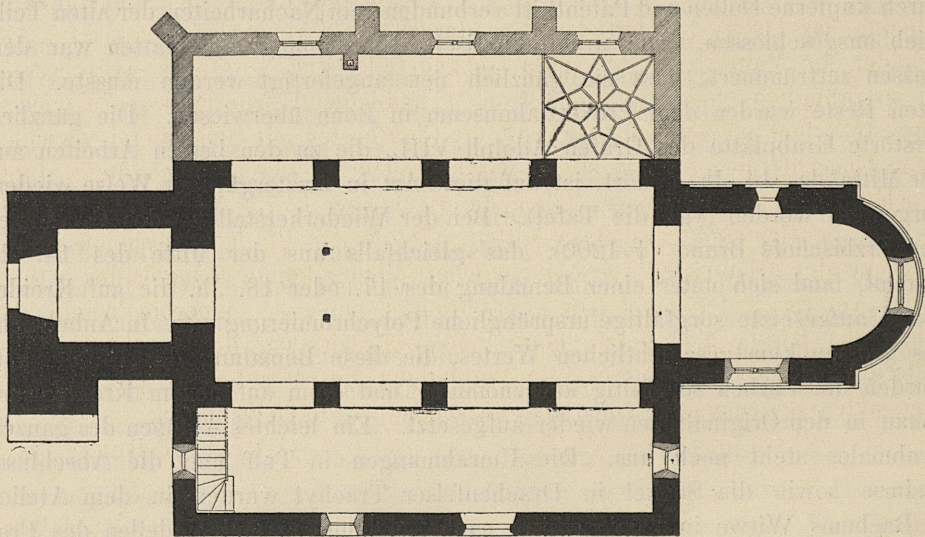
Flammerfeld. Grundriss der evangelischen Pfarrkirche.
